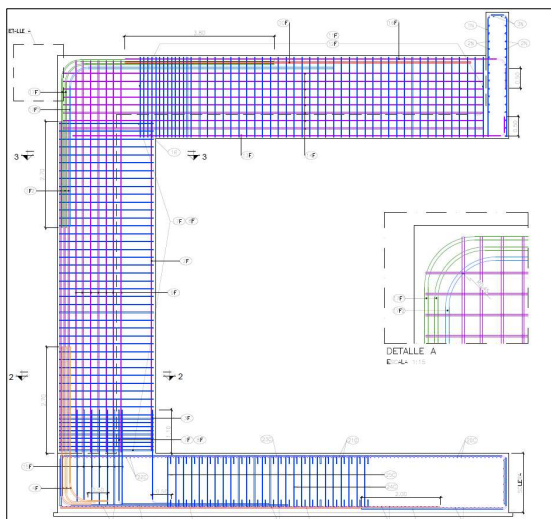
Sección de armado en zona de contrafuertes y visera nervada.
